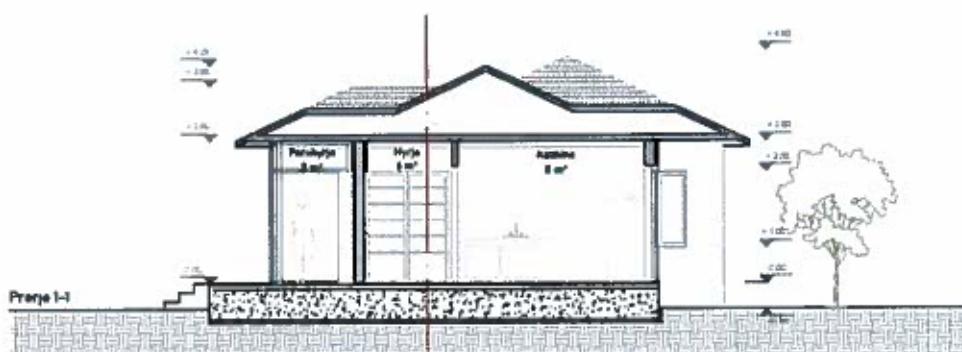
Planimetria e ndërtesave tip 3+1
